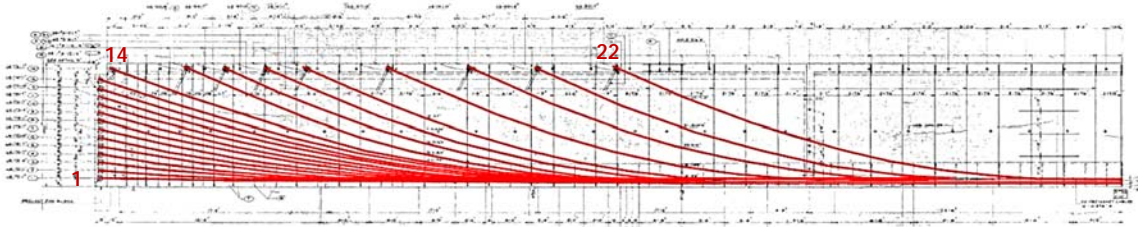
Vue en élévation d'une poutre préfabriquée de la section 7A (168'8") avec les 22 câbles de précontrainte longitudinaux en rouge
